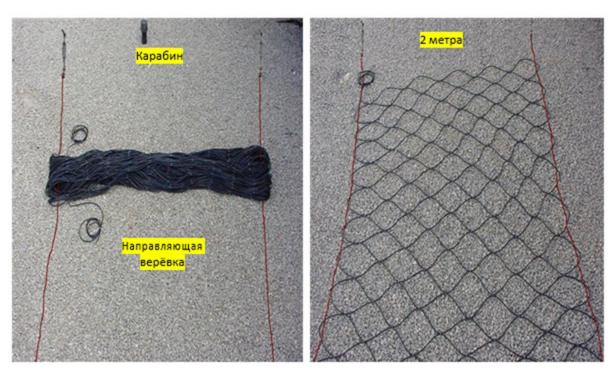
Схема монтажа сетки из чувствительного кабеля под землёй
